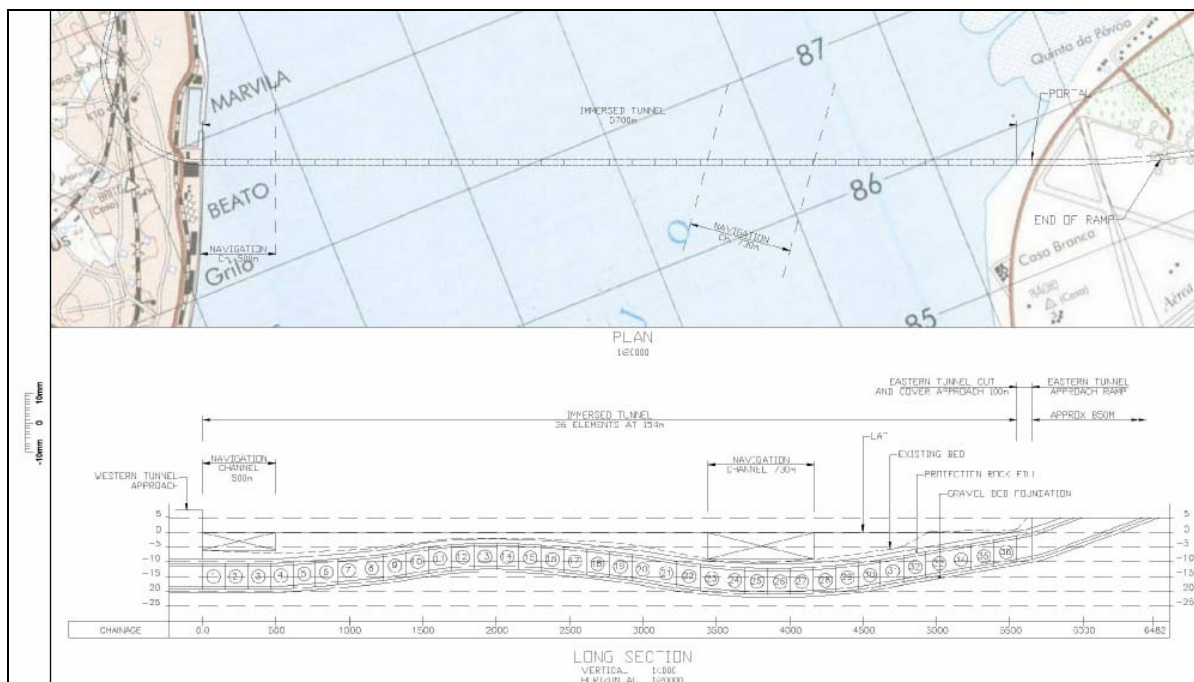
Planta e perfil longitudinal para a solução em túnel Beato-Montijo (fonte: CIP/Capita Symonds)
